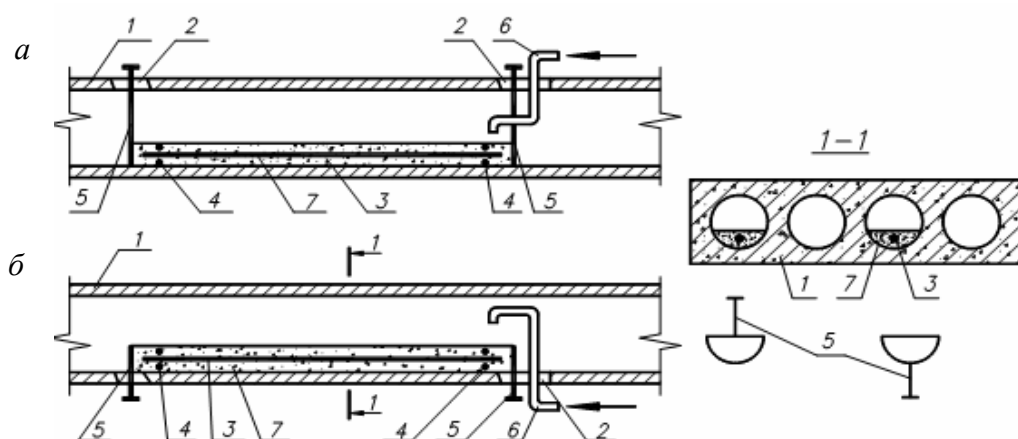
Усиление растянутой зоны многопустотных панелей установкой дополнительной арматуры: *а* – при устройстве щелей сверху плиты; *б* – при устройстве щелей снизу плиты, 1 – усиливаемая плита, 2 – щель, 3 – дополнительная арматура, 4 – фиксатор, 5 – ограничительная пластина, 6 – патрубок, 7 – полимерраствор
